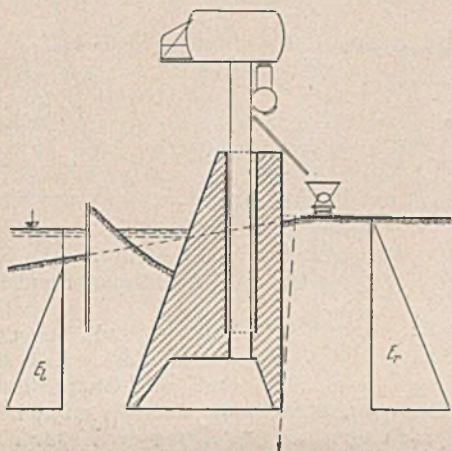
Ein unsymmetrischer Widerlager-senkkasten wandert beim Versenken nach dem Wasser zu ab.
